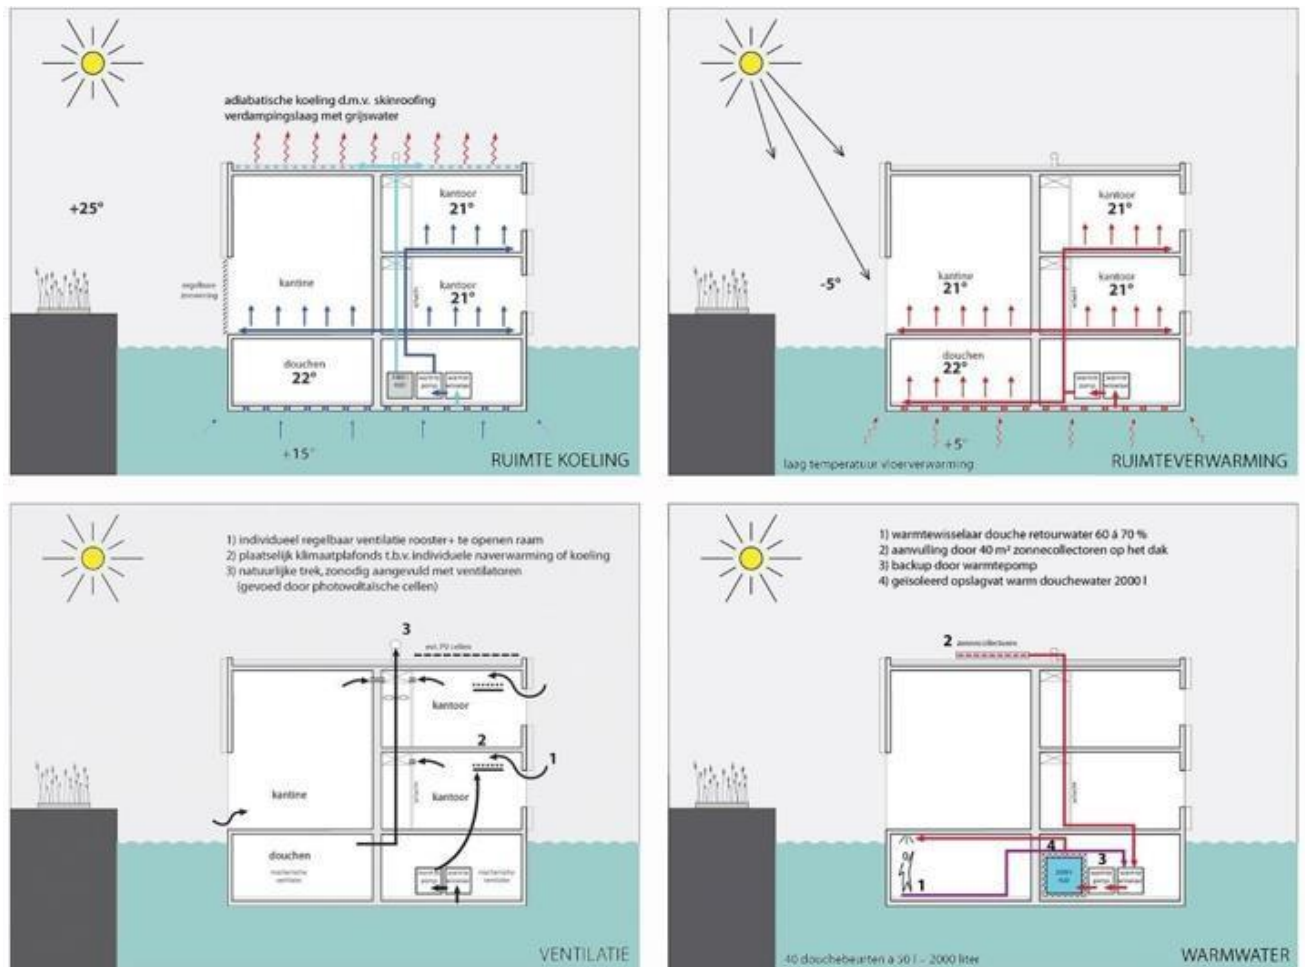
Схема роботи опалення, теплопостачання та вентиляції будинку Werkhaven Waternet [ 31]
